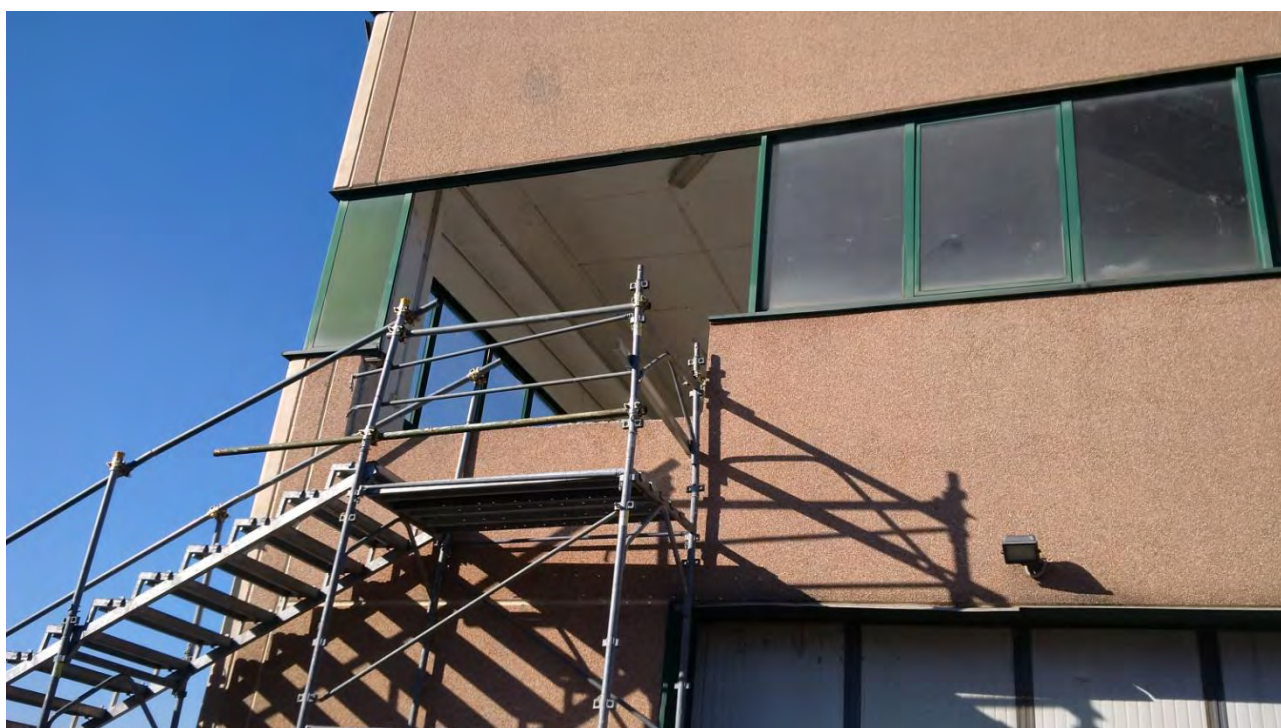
ACCESSO AL LOC.1 DALLA SCALA RICAVATA SU PONTEGGIO DA CANTIERE
